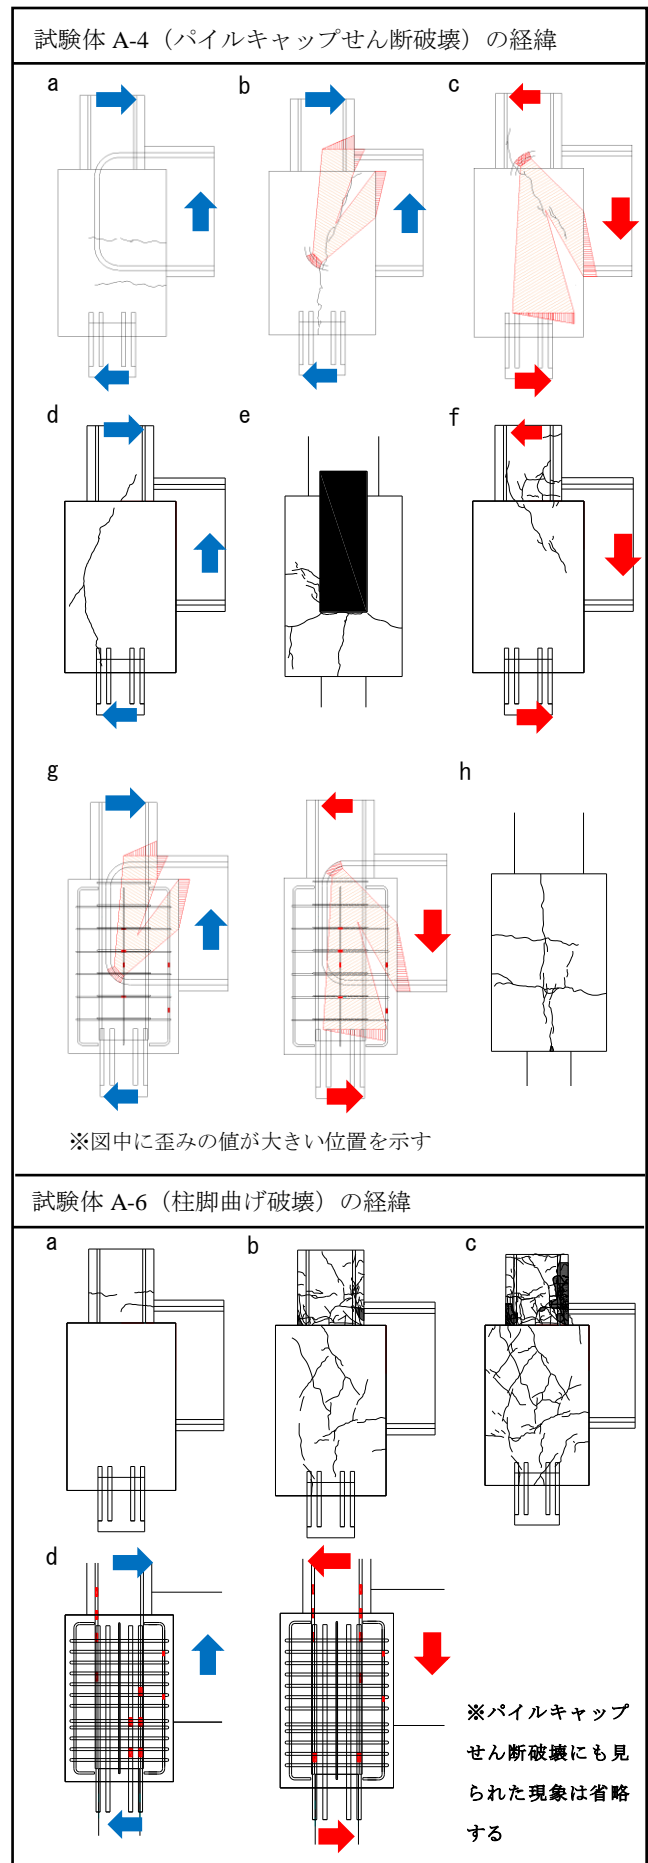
ひび割れおよび鉄筋の降伏状況の経緯
